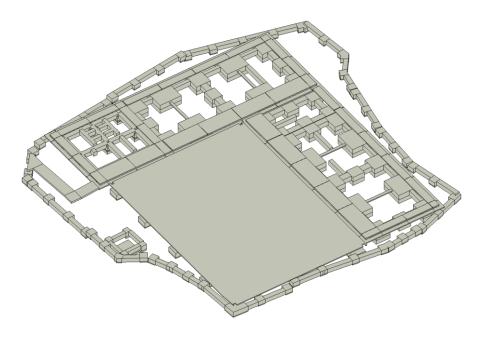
Categoría Cimentación Estructural aislada del modelo federado de Estructuras Fuente: Adaptado de Revit Autodesk 2021.
